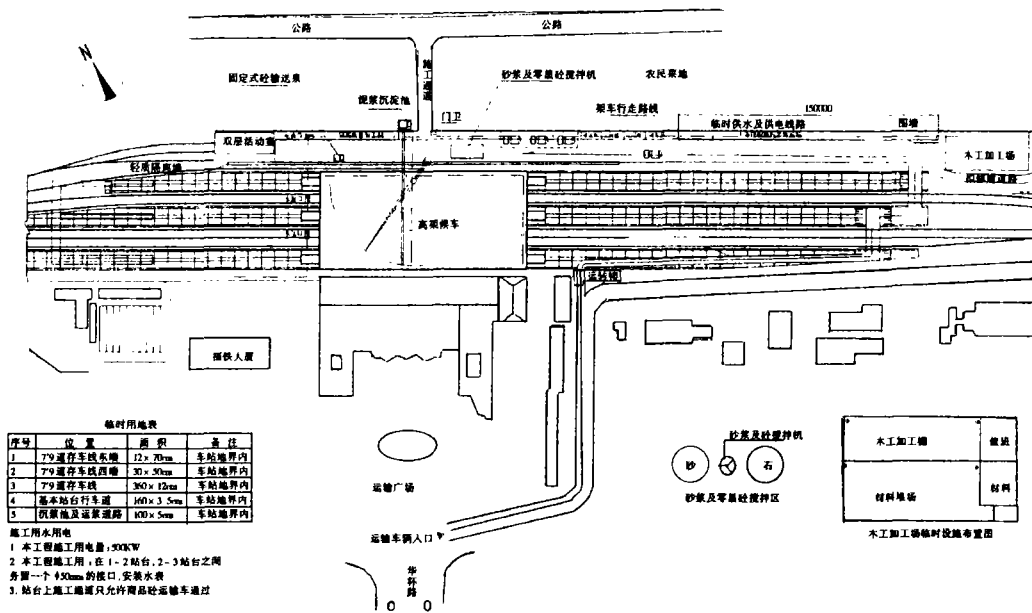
福州火车站站房改造高架候车室工程施工总平面布置图
